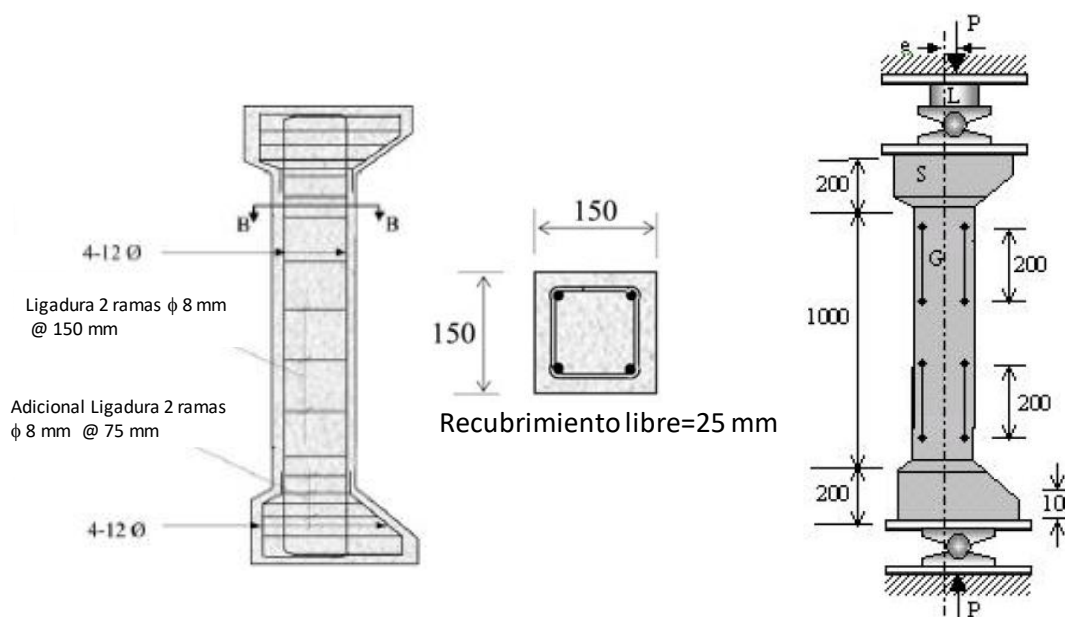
Configuración del ensayo, detalles del armado y sección transversal de la columna original (KALIYAPERUMAL *et al*, 2009 Modificado).
